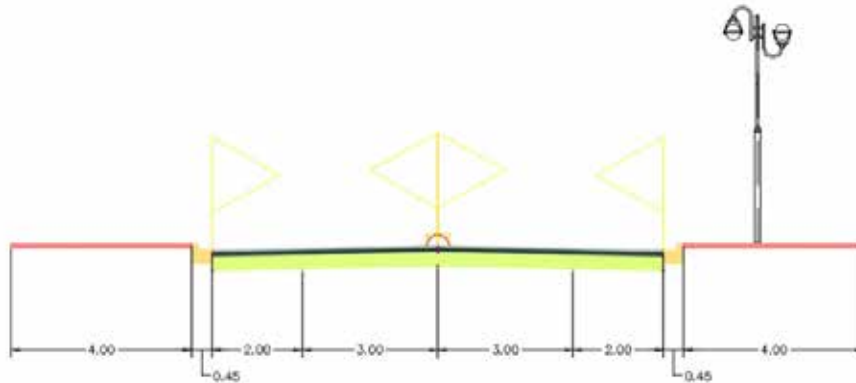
Sección transversal de la calle Rondón (Tramo 1).
